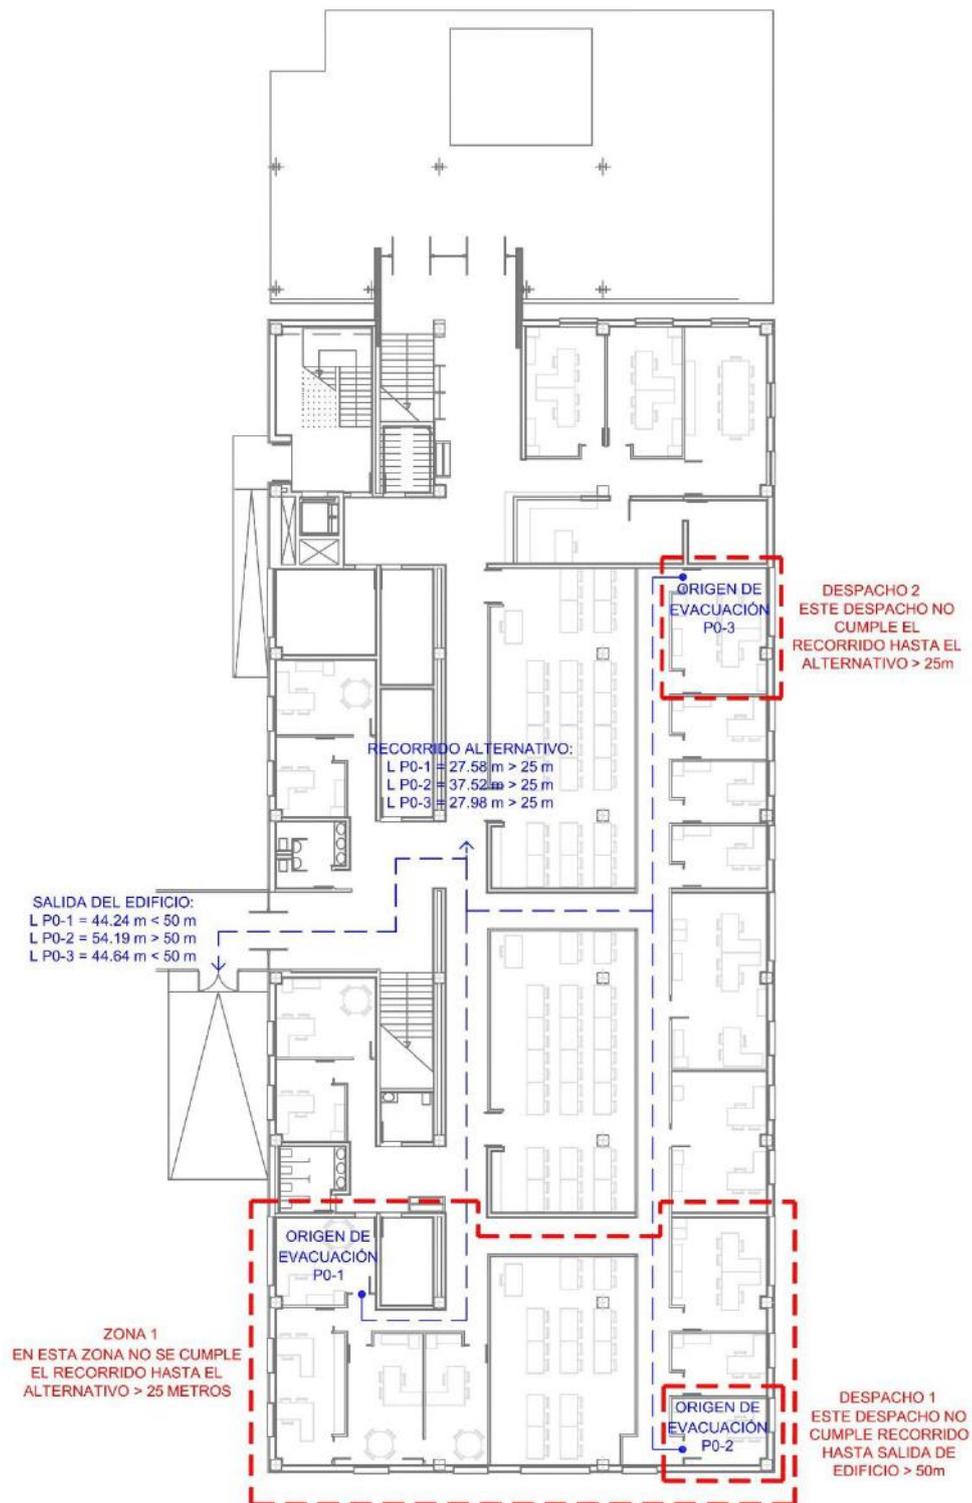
Cumplimiento Longitud Recorridos de Evacuación Planta Baja. Figura extraída del plano 40.
